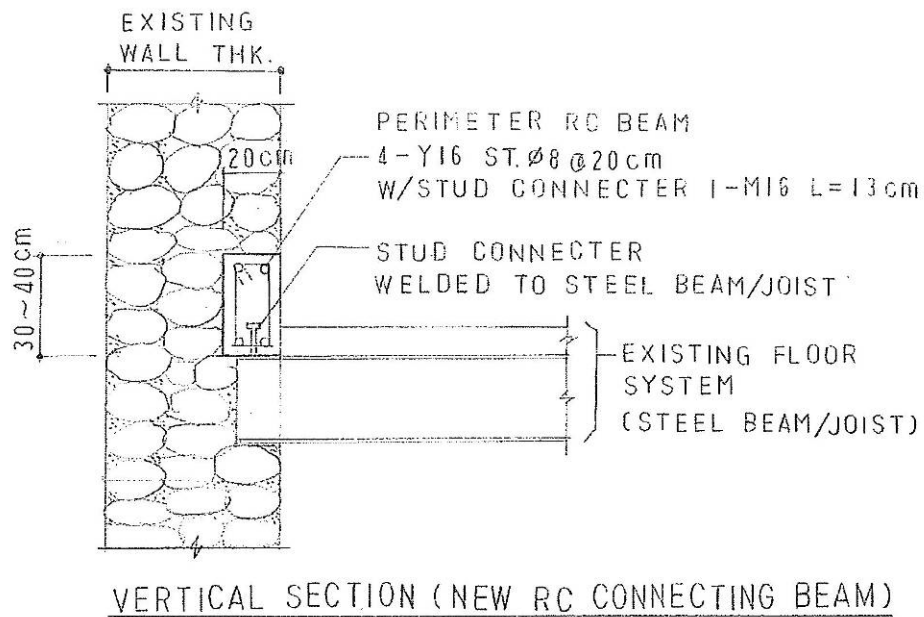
Détails typiques des nouvelles poutres de raccordement en BA et des nouveaux murs de cisaillement en BA
